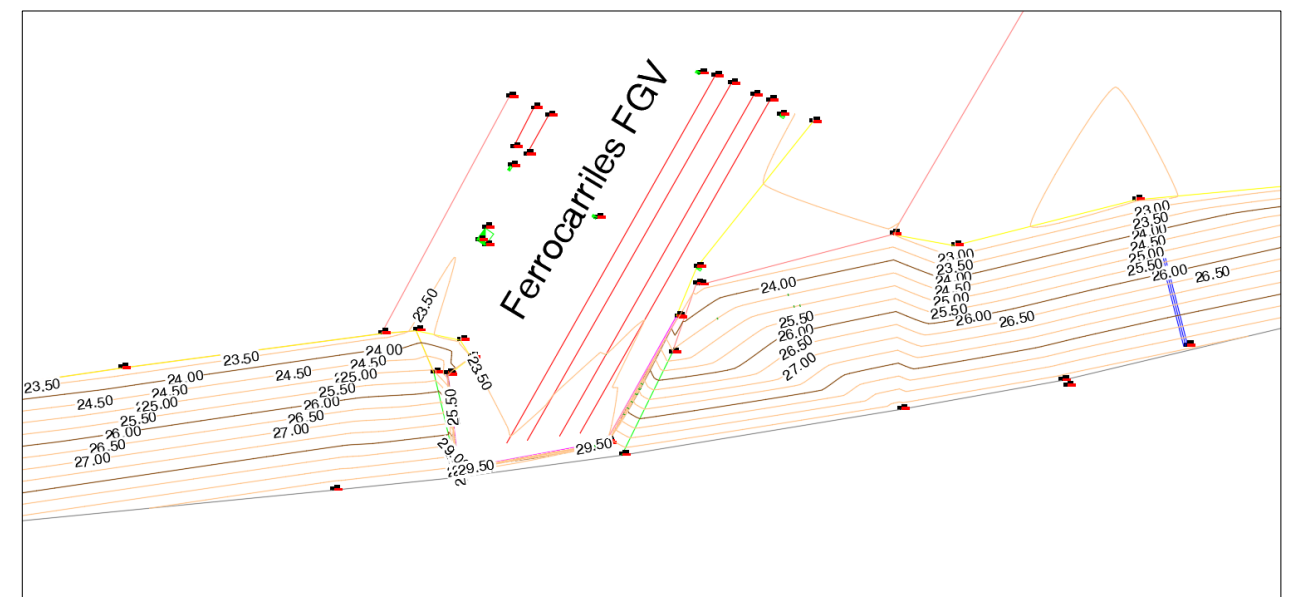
Vista transversal emplazamiento. (Fuente:AutoCad)
